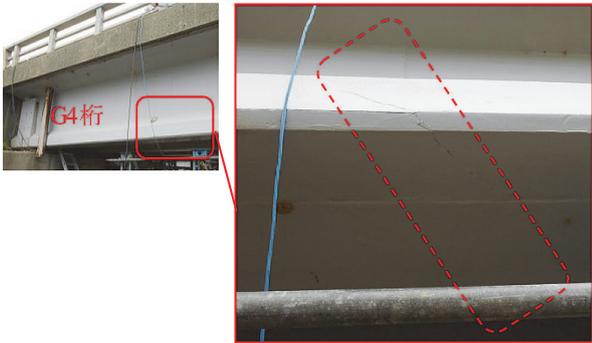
G4桁 ねじりによるひび割れ
